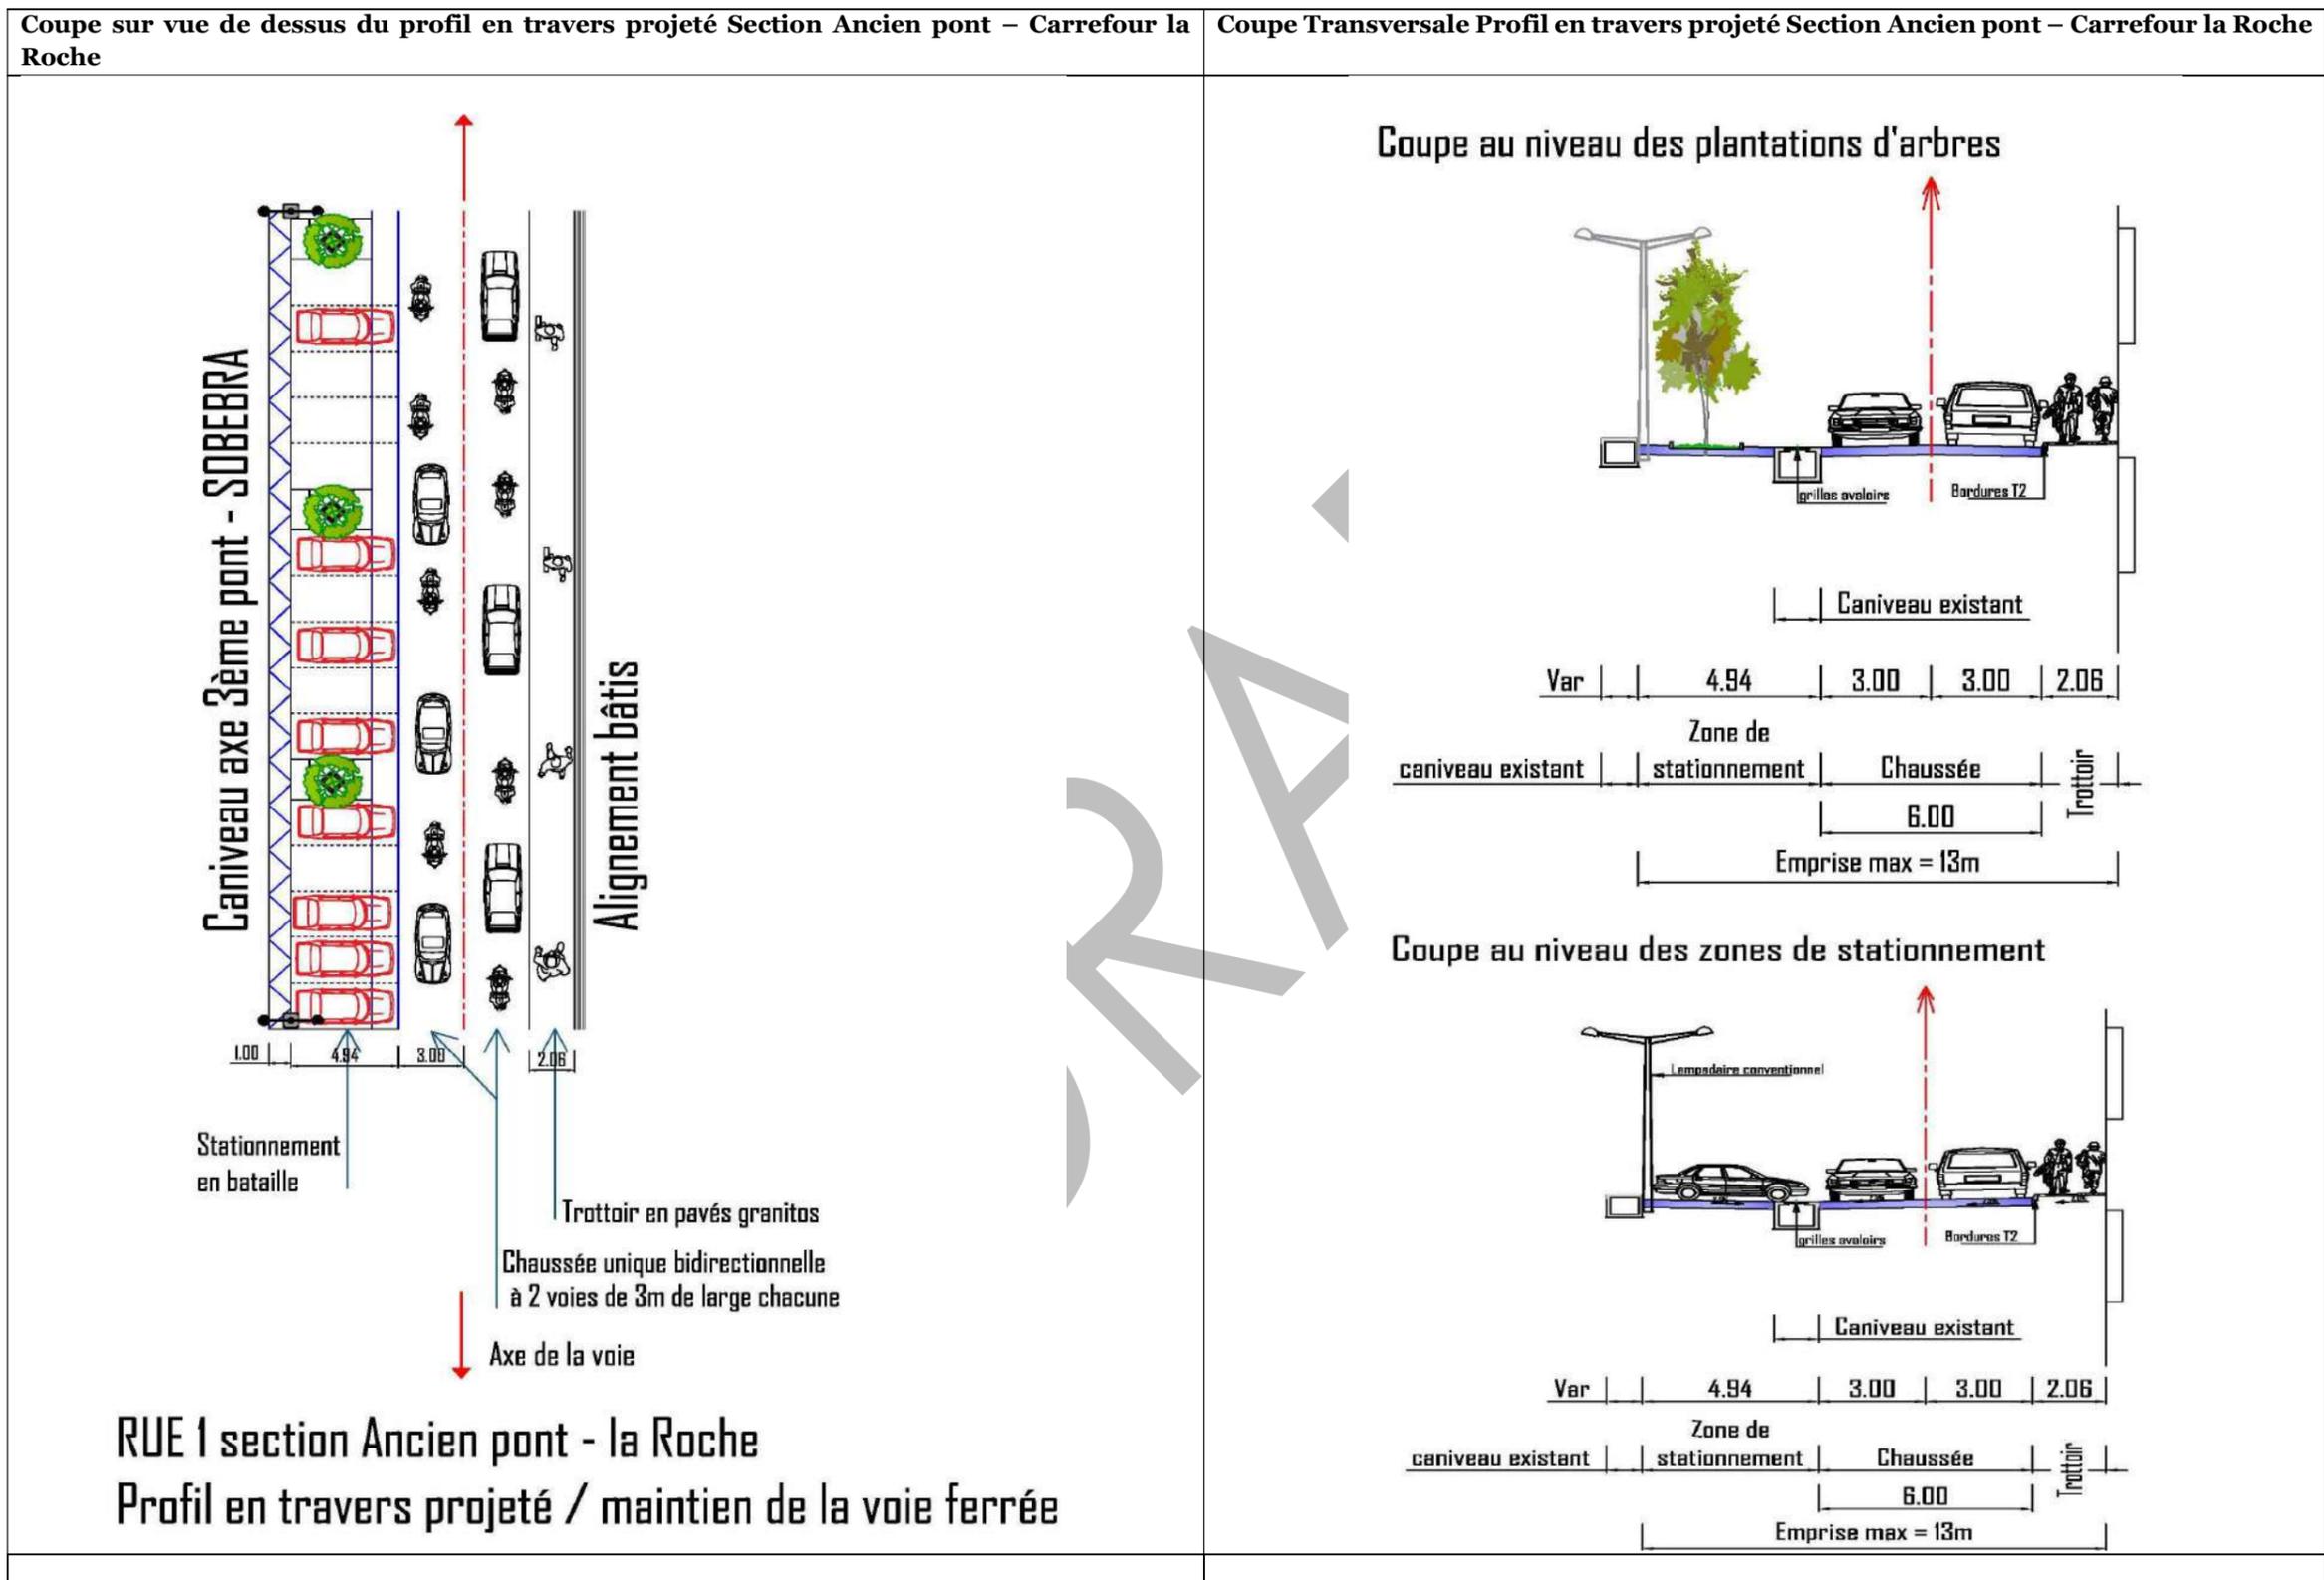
Profil en travers pour la Section Ancien pont – Carrefour la Roche
